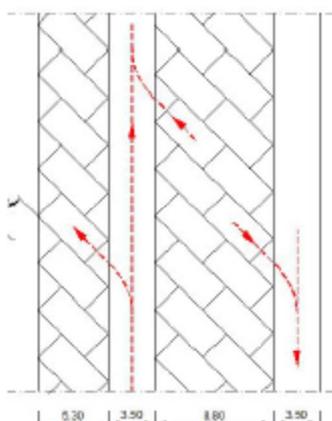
esempio di parcheggio con utilizzo di pavimentazioni drenanti
